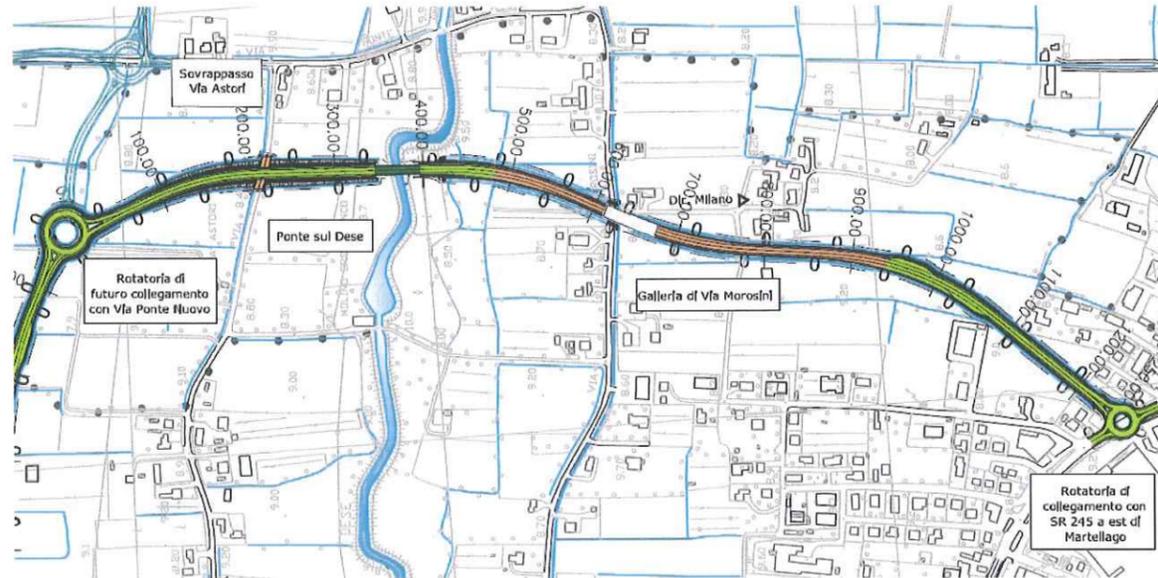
Viabilità di collegamento ad est – tratto dir. nord-sud
